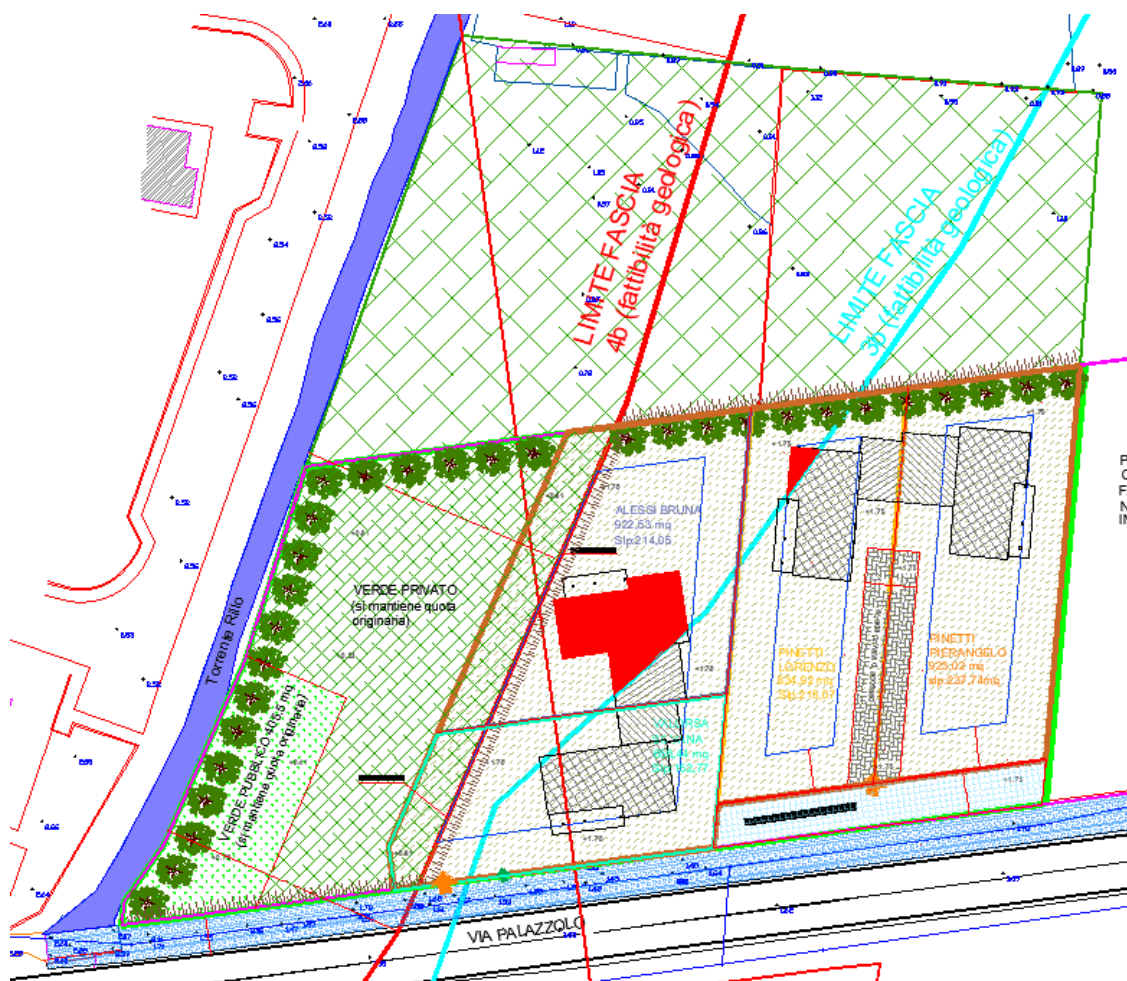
Planimetria di progetto, fasce di compatibilità geologica ed estensione coperture impermeabili (in rosso).
